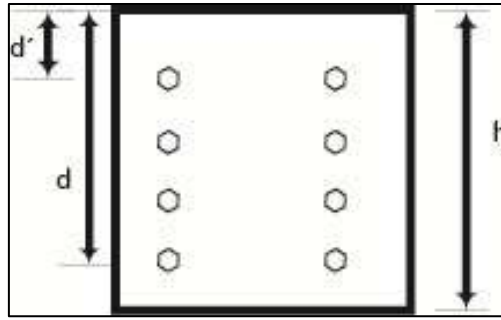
Ilustración de columna; Fuente: [Grupo investigador]
